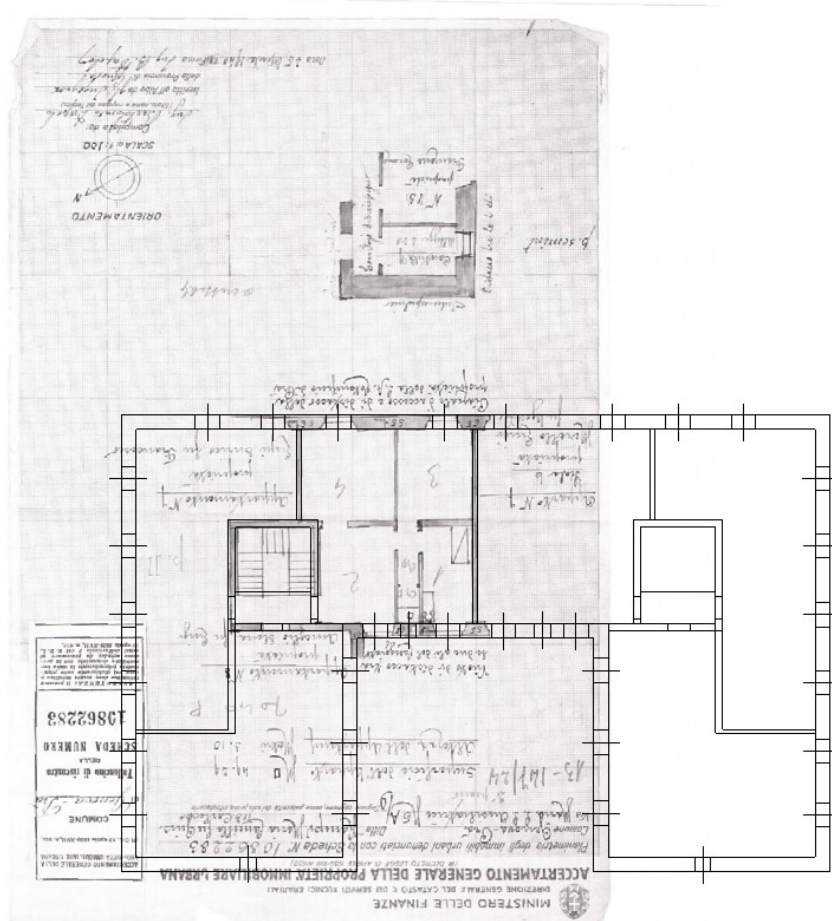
Posizionamento planimetrie catastali e planimetria-tipo DWG
